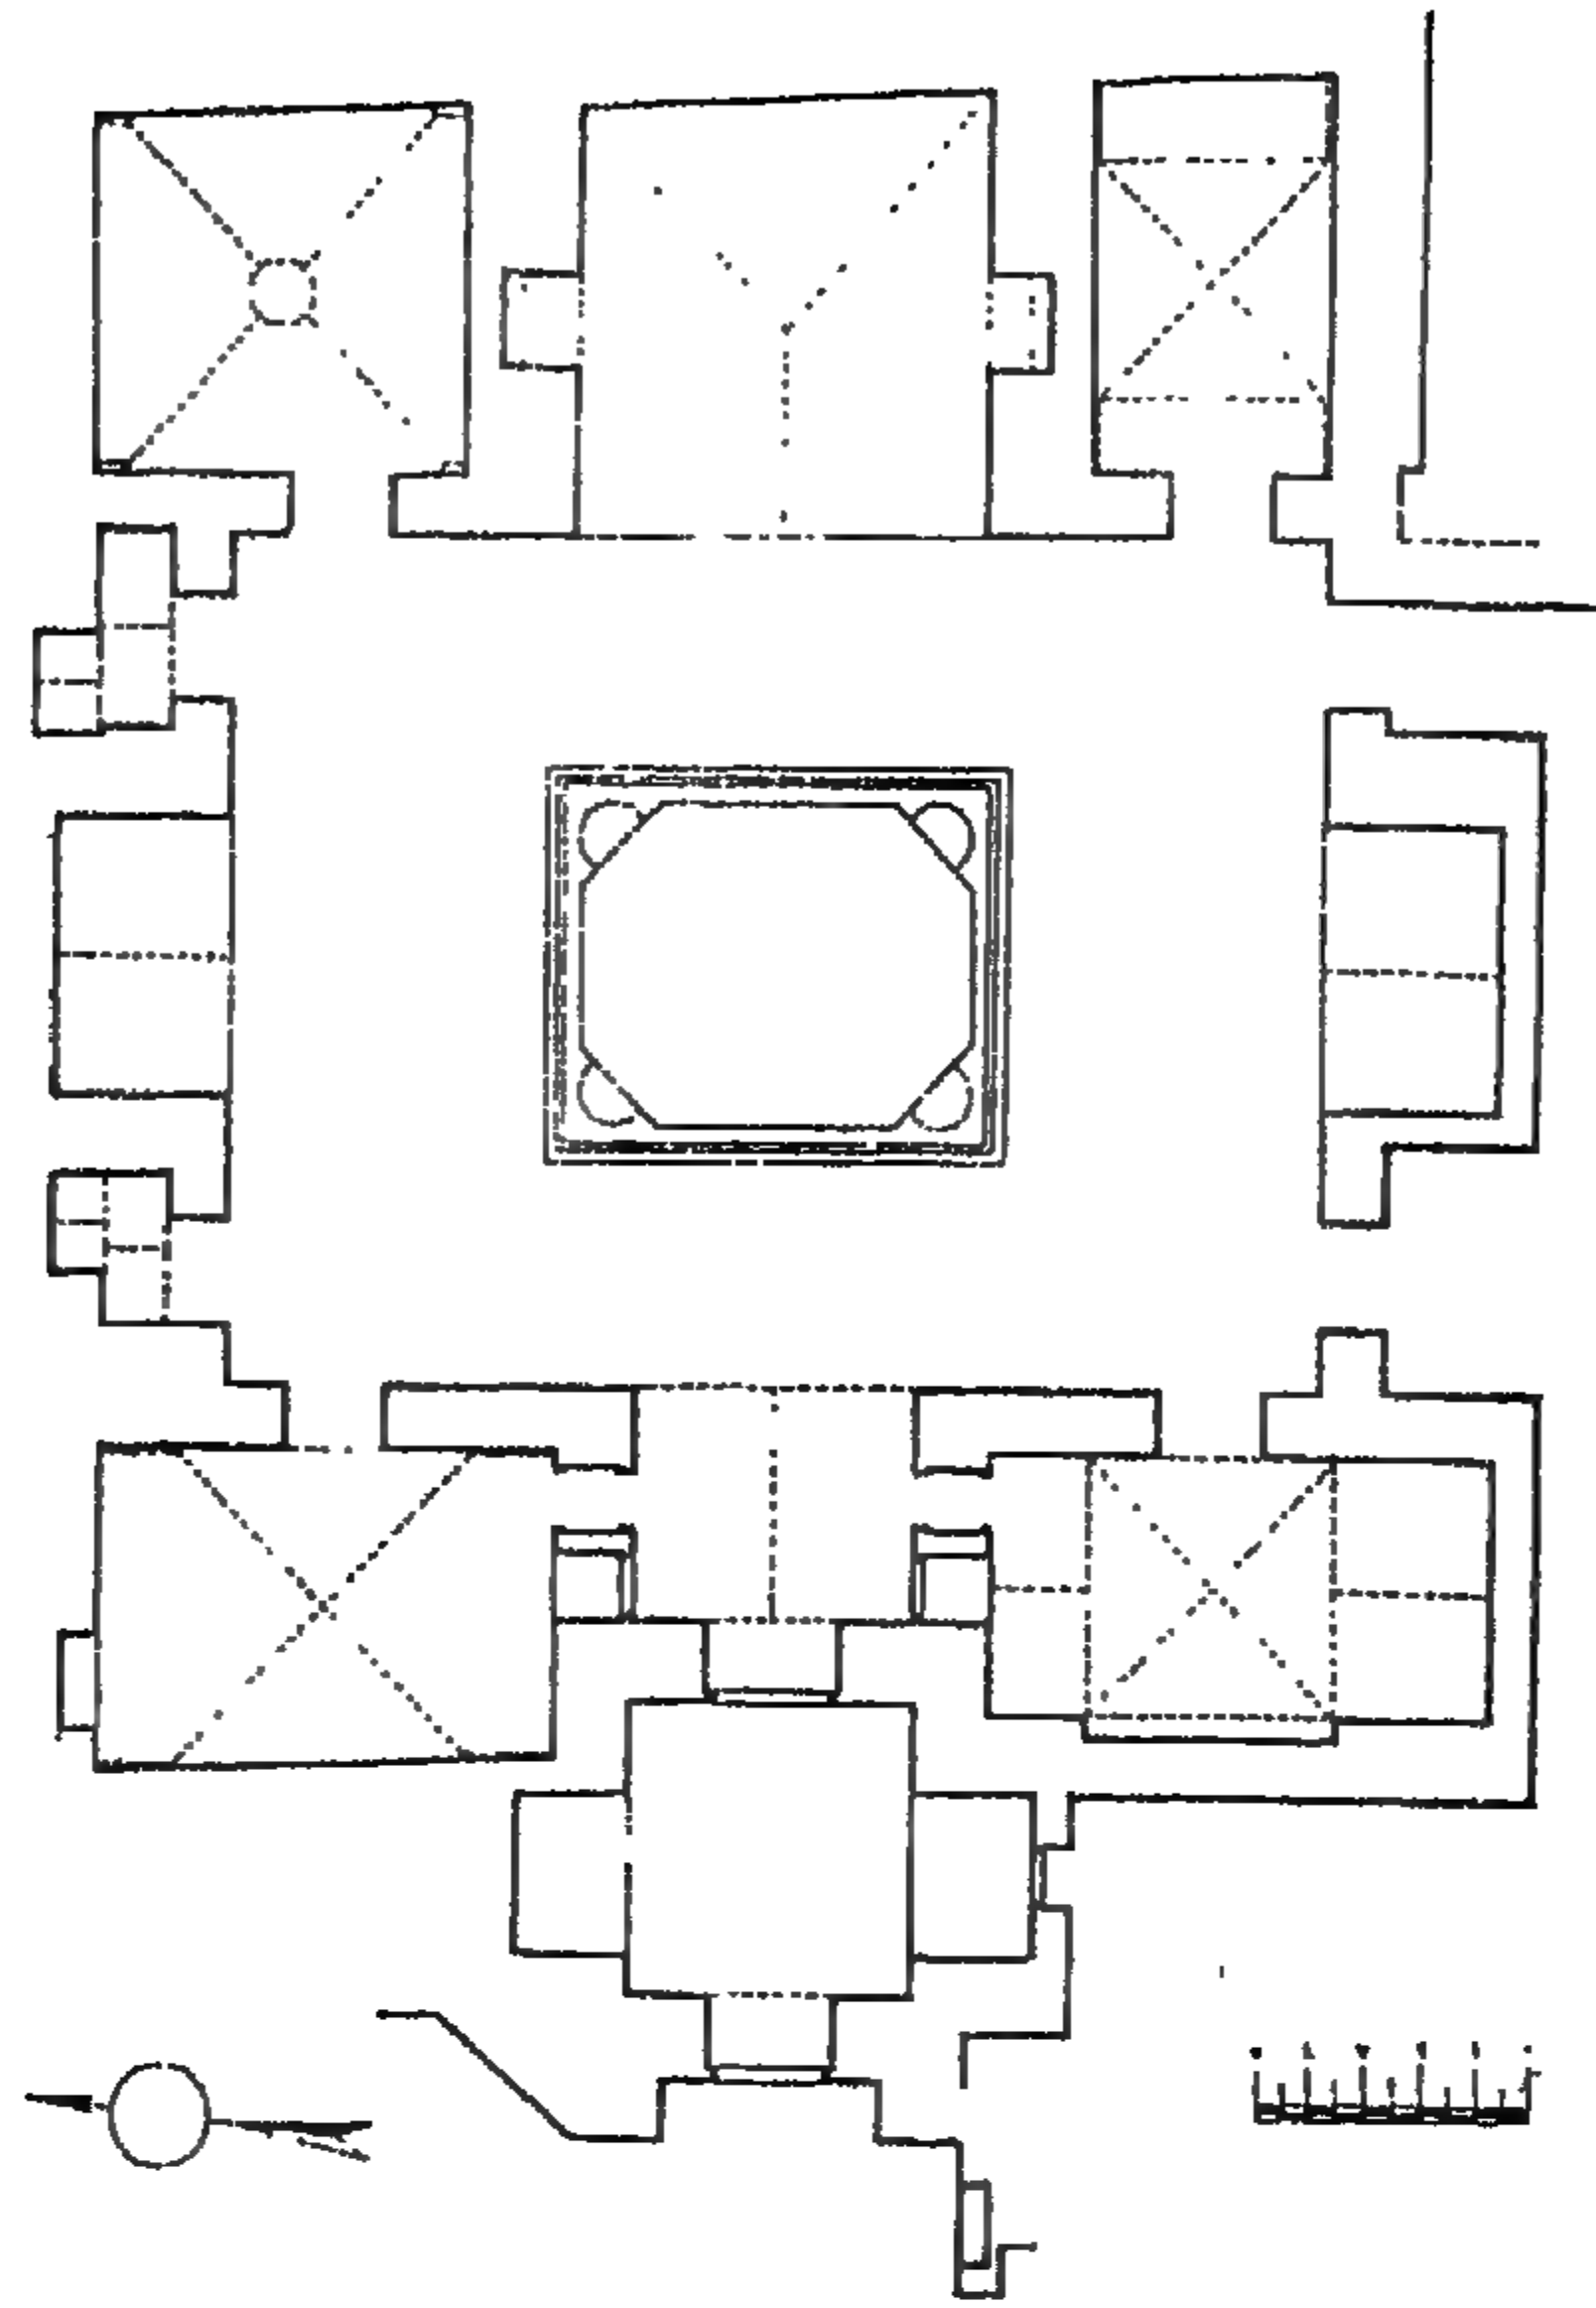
مسقط أفقي للخانقاة والتربة المعروفة
